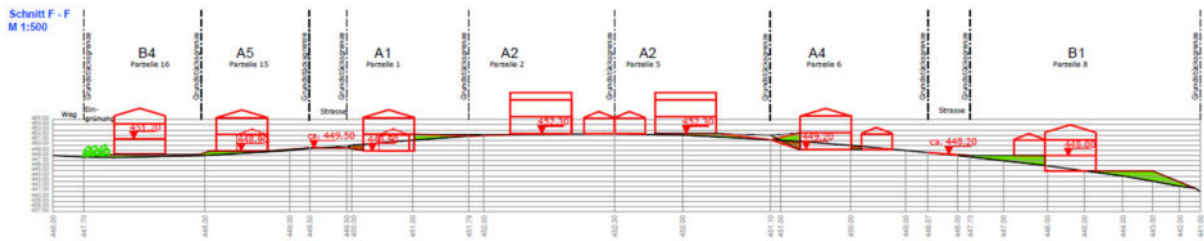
Auszug aus dem beiliegenden Beiplan für die Geländemodellierung und die Festsetzung der Höhenbezugspunkte zum Bebauungsplan – Schnitt F - F (ohne Maßstab); Planung Jocham + Kellhuber (Nov. 2021)
